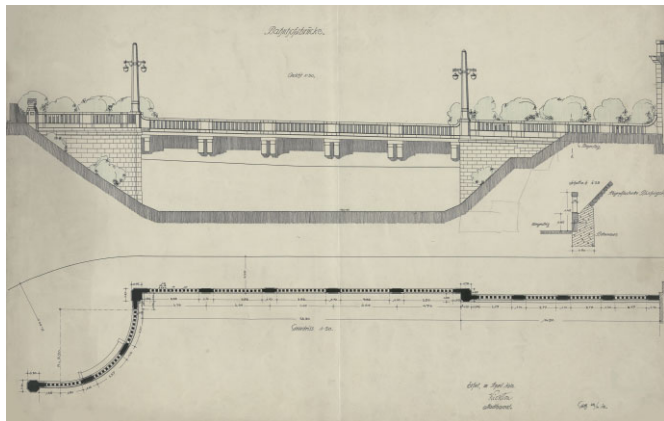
Station Bridge – Bauwerksplan – HERMANN KICKTON – 1912
